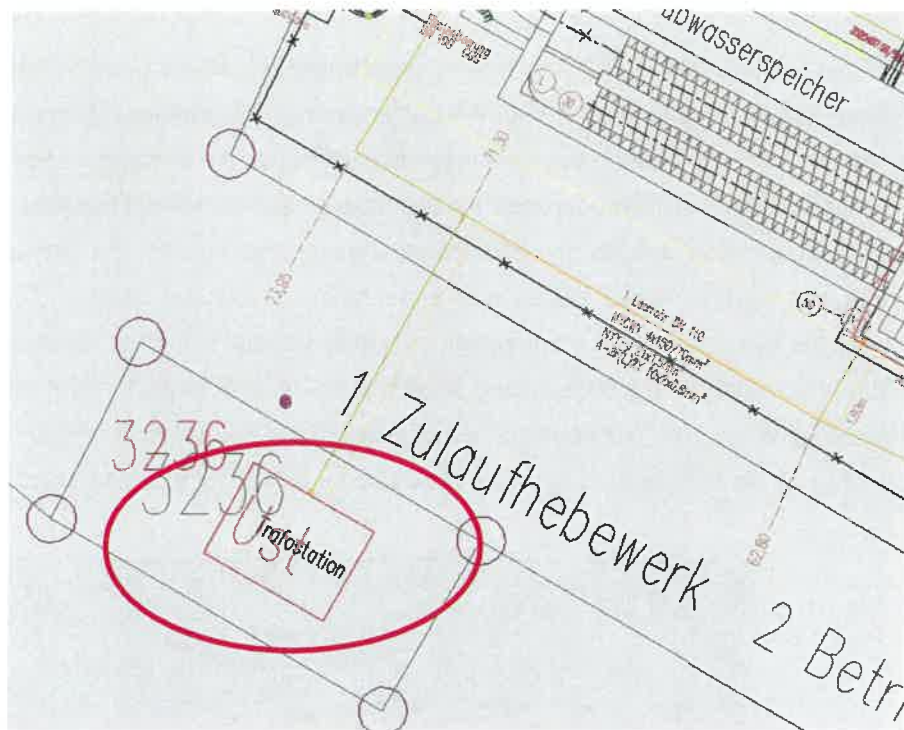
Lageplanausschnitt Bestand Trafostation
